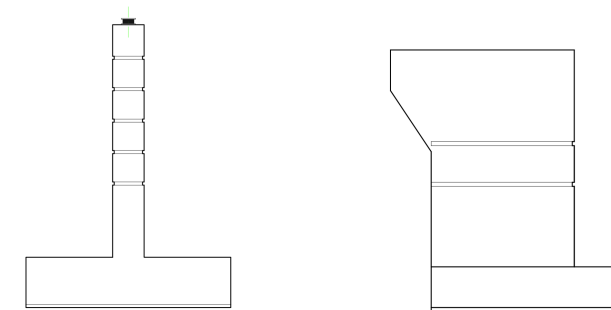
e. Alzado longitudinal de la pila y del estribo.
